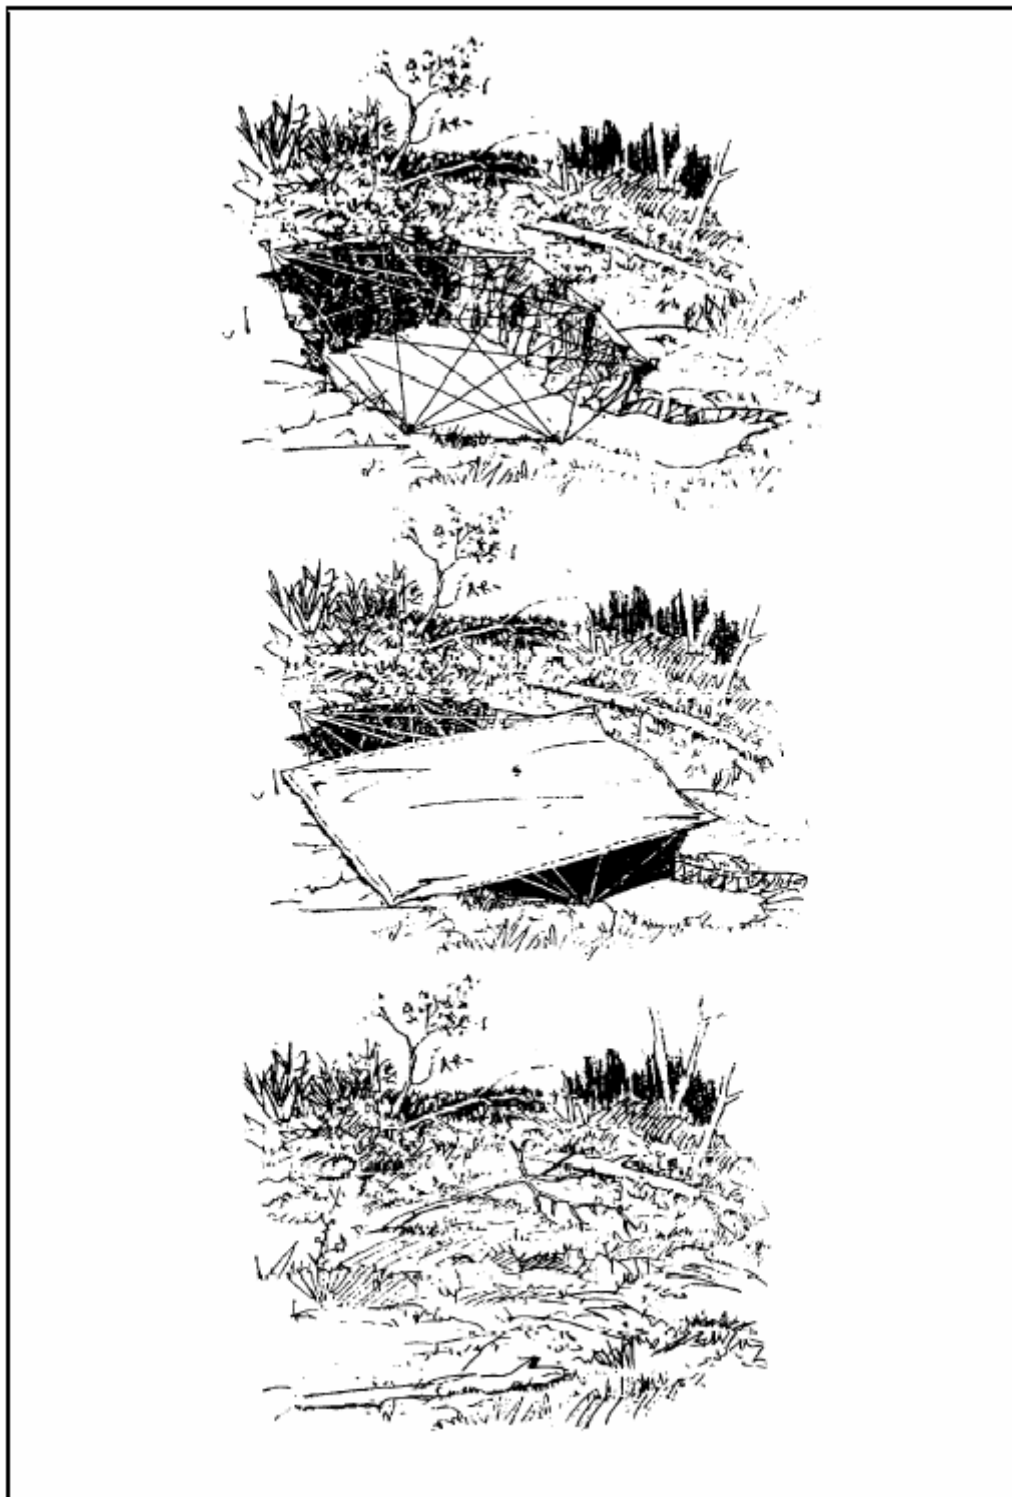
Укрытие с перекрытием из натянутых шнуров.
